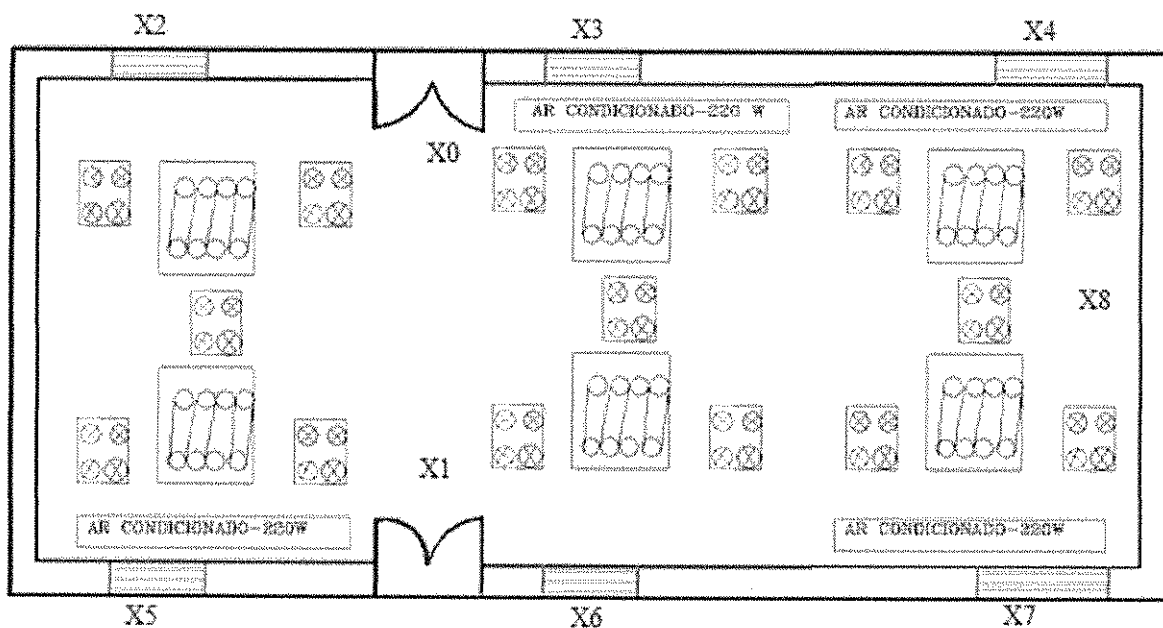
Planta do Anfiteatro II. (fonte: Autor)
